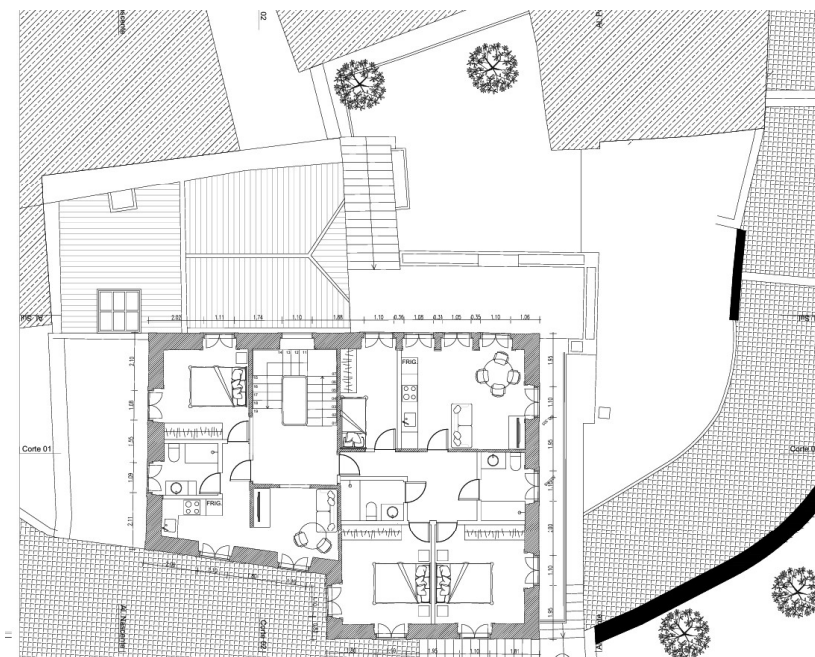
Estudo de Layout Piso 1 no Autocad (s/escala) | Beatriz Figueiredo
